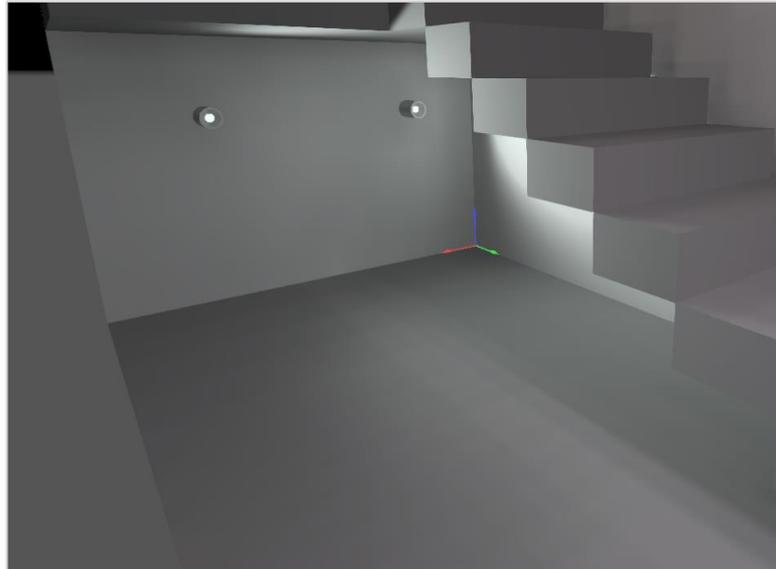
Situación luminarias de la zona debajo de las escaleras de la planta baja (fuente propia).
